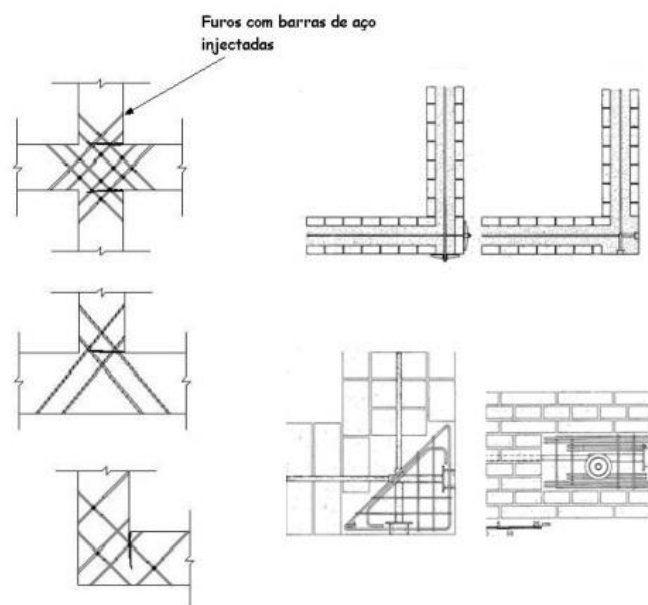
Pregagens de costura em paredes ortogonais com pormenor construtivo de uma parede exterior de canto [46]
